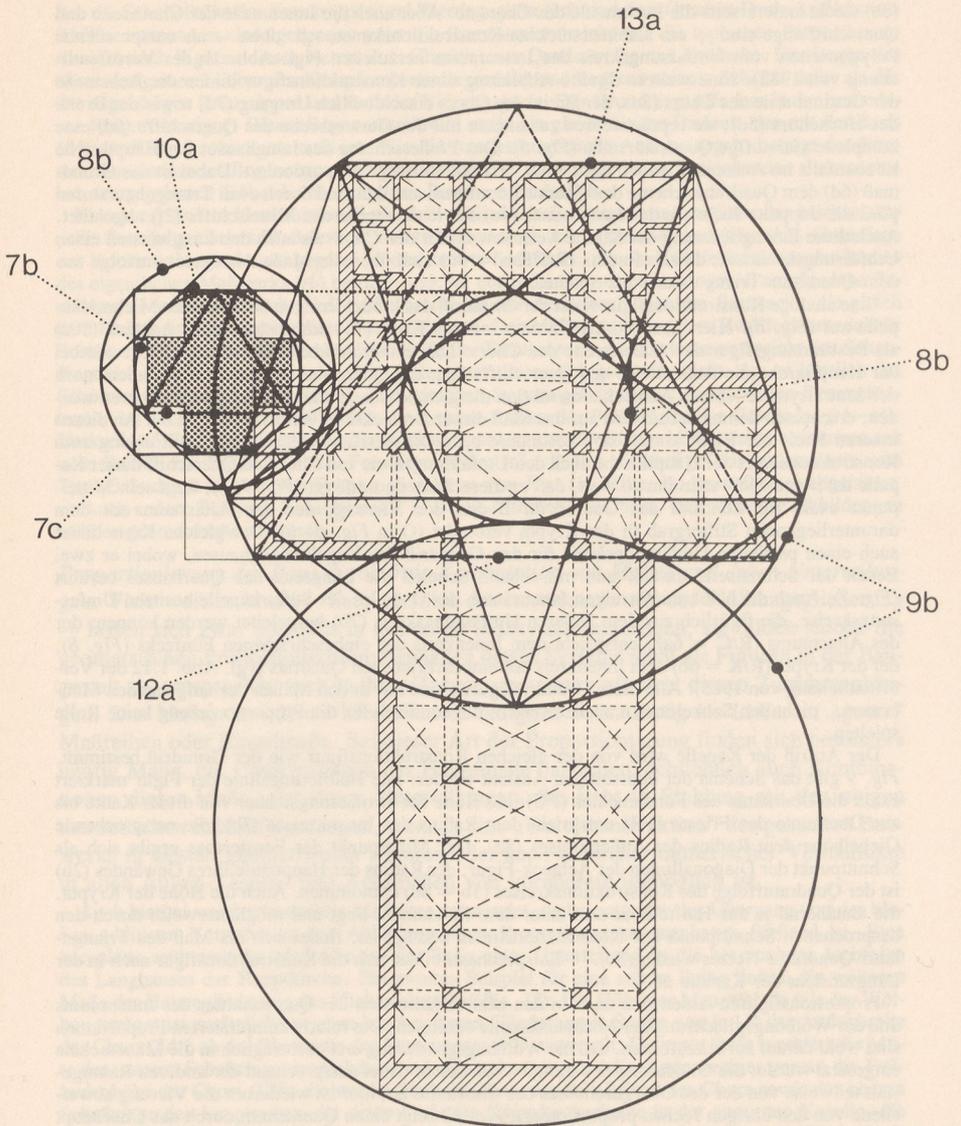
Schematischer Grundriß der Abteikirche mit der geometrischen Grundfigur der Proportionsbeziehungen.
